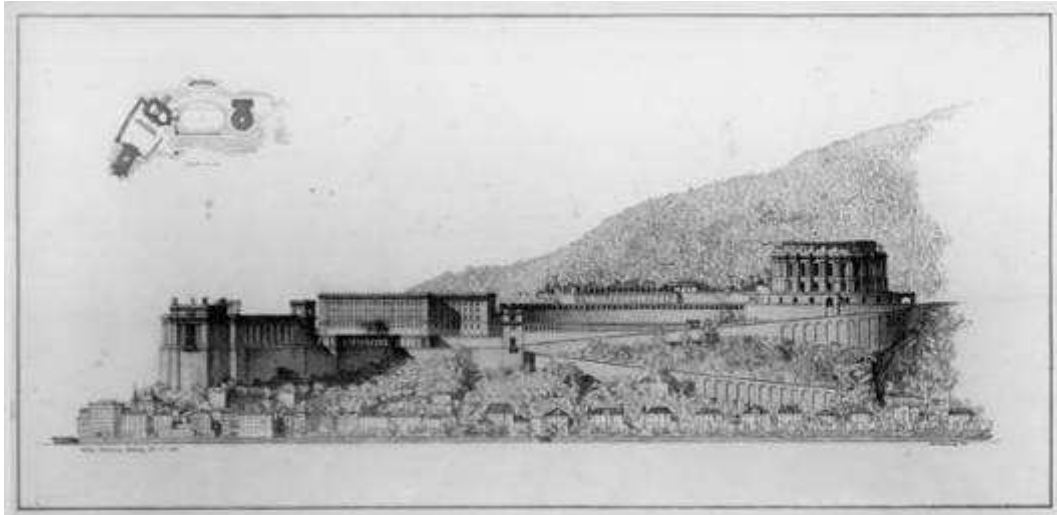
Otto Strohmayr, Ansicht mit Lageplan links oben, Imbergverbauung, Salzburg, 1942 (HSS, INR 004.564).
